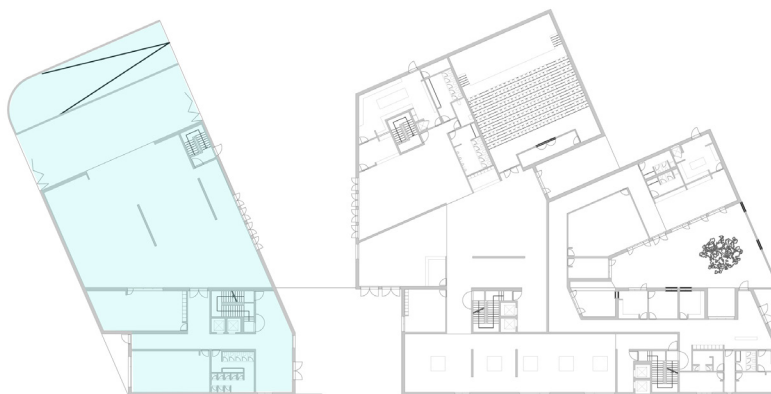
Planta esquemática Piso 0 - zona do armazém
